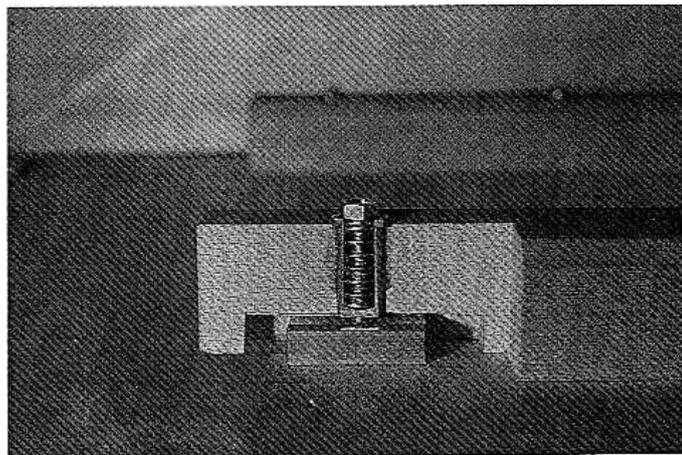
Detalle del sistema ya colocado en el nuevo travesaño.
